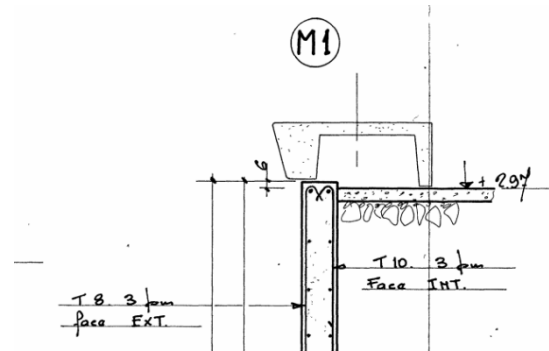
Extrait plan 79.705.B2 - MURS M1 et M2. MASSIFS E' 13, 14, 15
